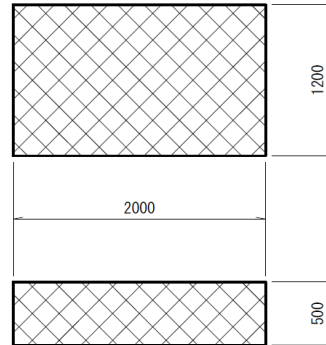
(2) 沈砂池の構造例 (ふとんかご)
